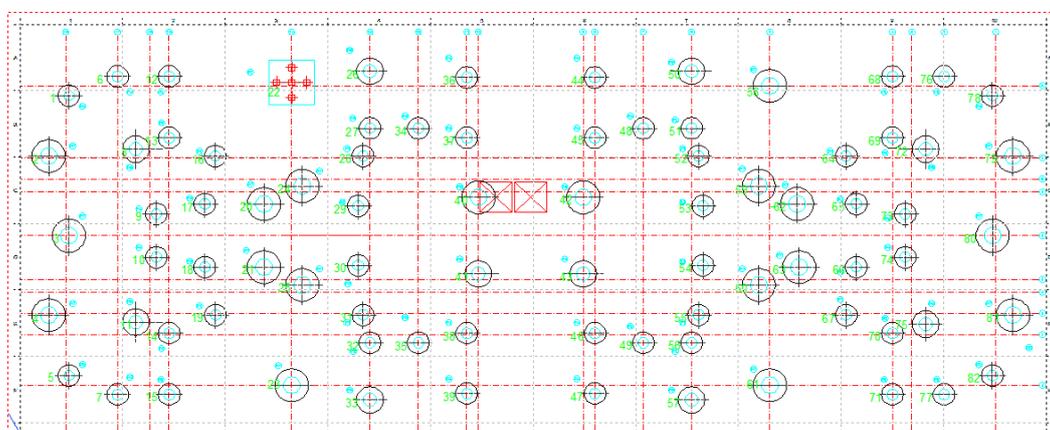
Ubicación y distribución en planta del proyecto.
